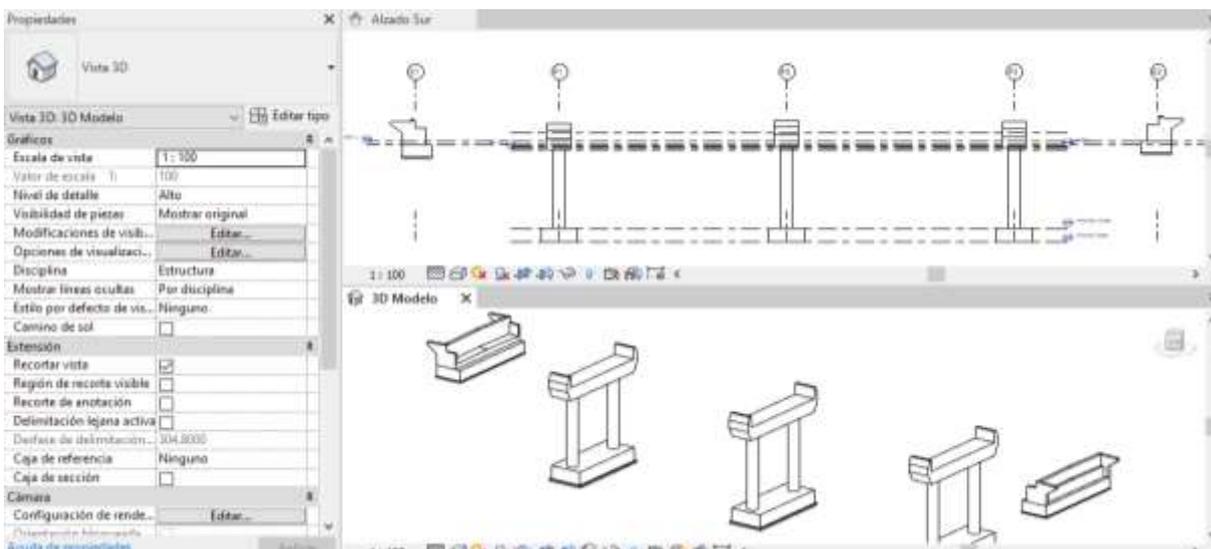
Pilas y Estribos del Modelo 3D. Fuente: El. prop.
